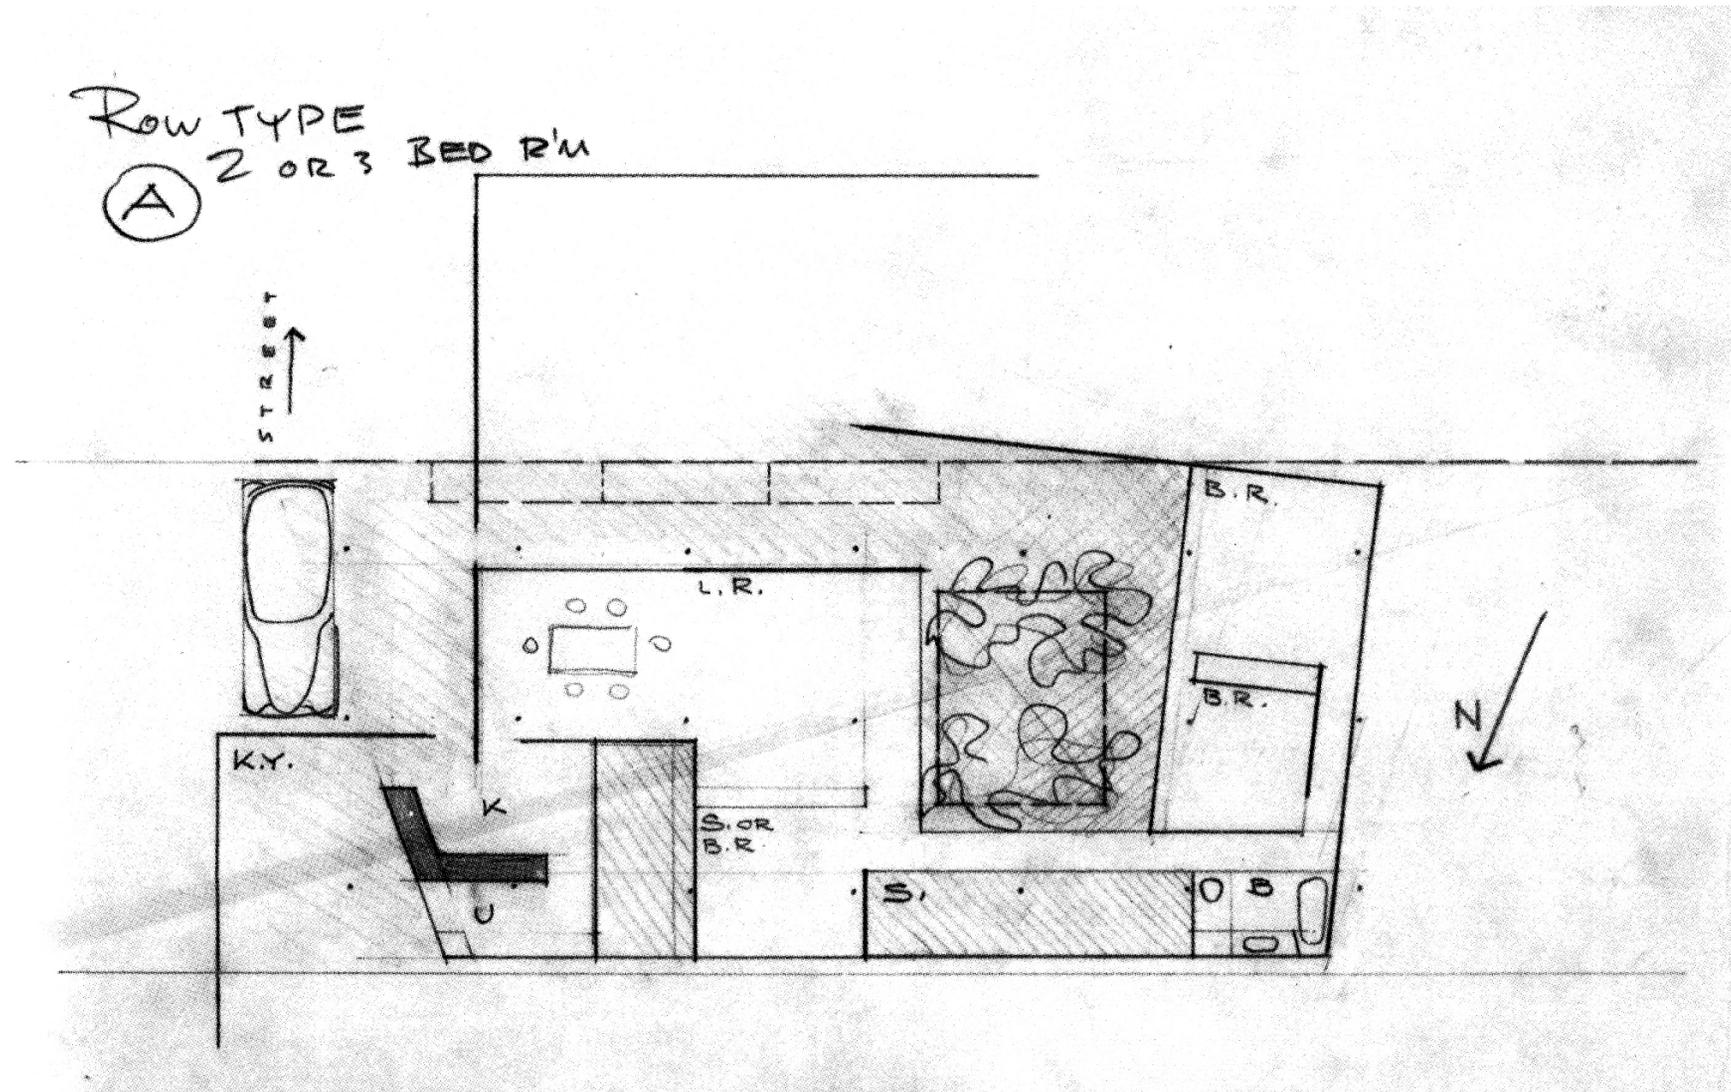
Kahn y Stonorov. Planta vivienda tipo A. 1944.
